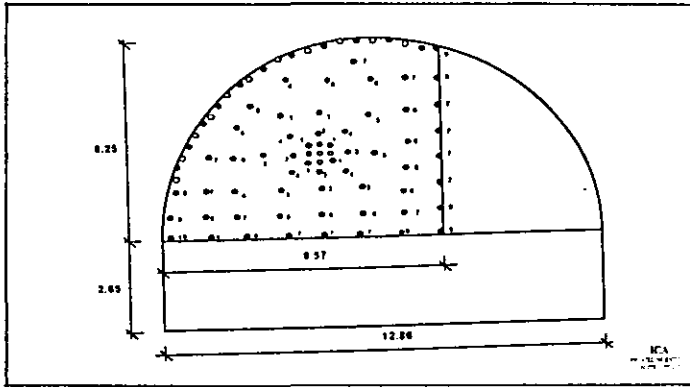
Diagrama de barrenación para $\frac{2}{3}$ de sección.
